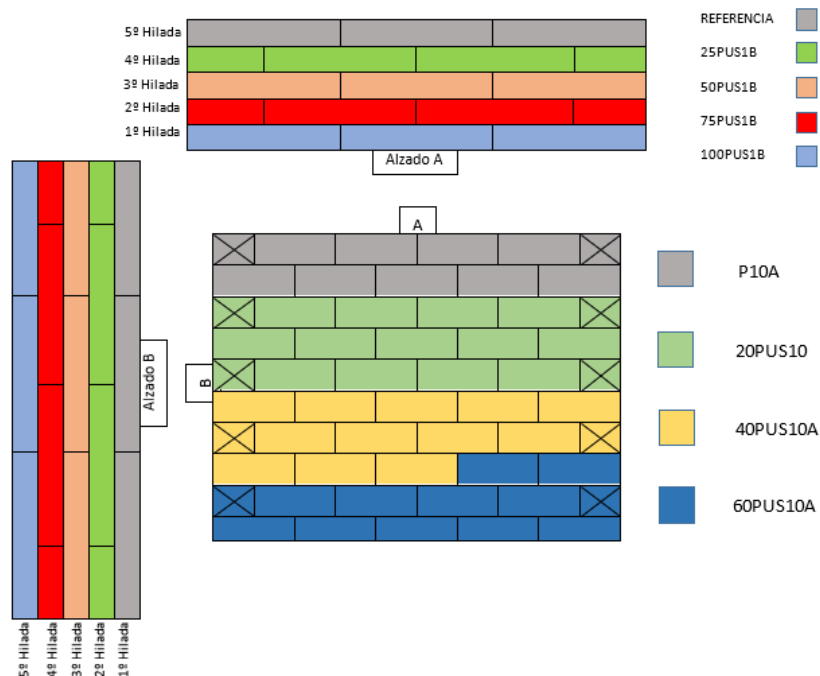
Distribución de piezas en el demostrador. Alzado B (izq.); Alzado A (centro sup.); planta (centro inferior)
